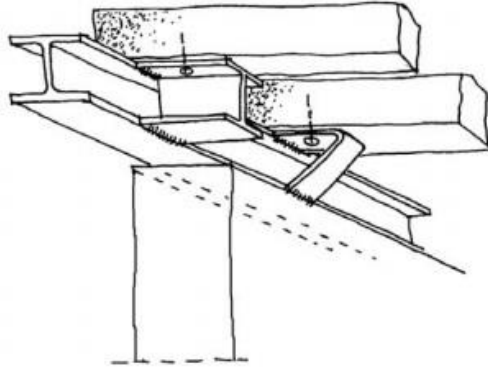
Refuerzo de viguetas. <http://oa.upm.es/53437/1/L032009TCXIMadera.pdf>
